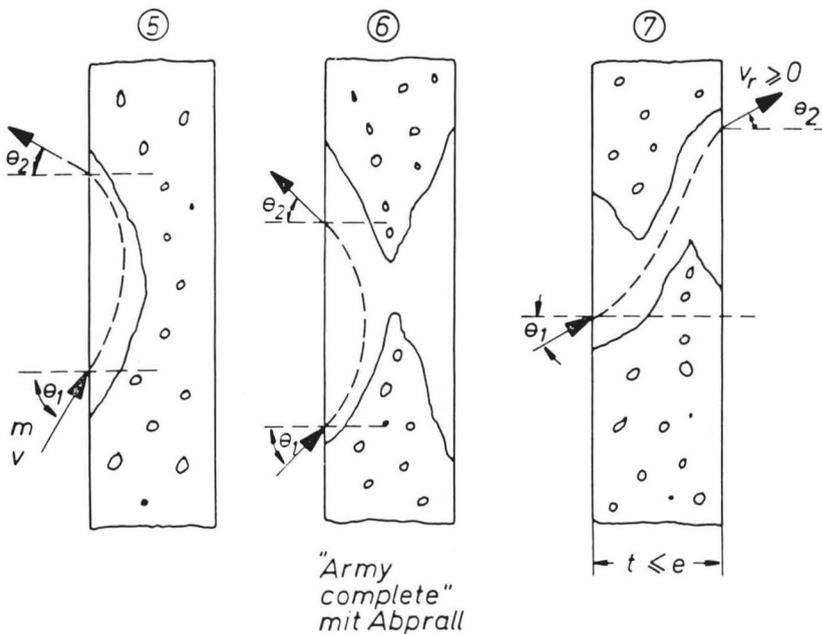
a, b: Schadensbilder beim Beschuss von Betonplatten (schematisch)
